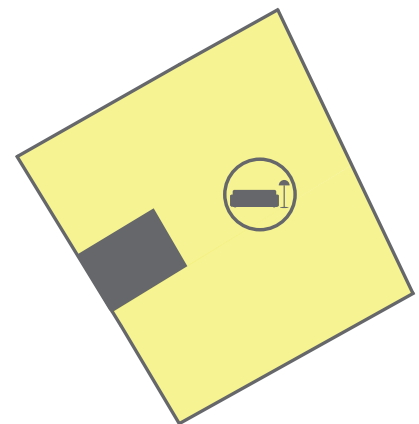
Grundrisse OG und DG Variante Umbau
